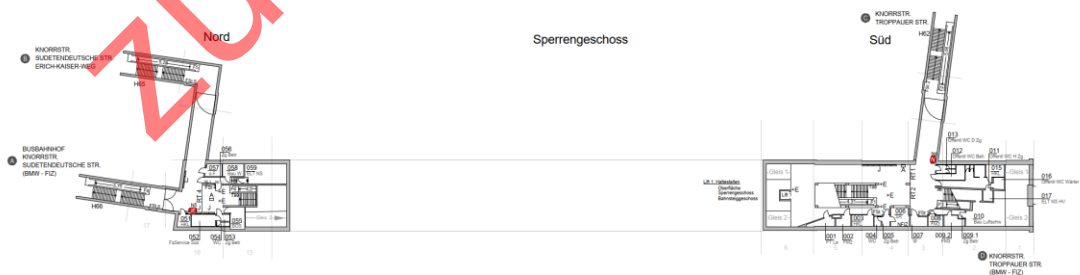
Grundriss Sperrengeschoss HA
